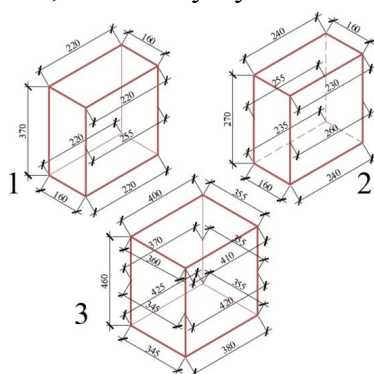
Розміри зразків: 1, 2 – важкий бетон; 3 – керамзитобетон / Fig. 1. Dimensions of samples: 1, 2 – heavy concrete; 3 – claydite-concrete
